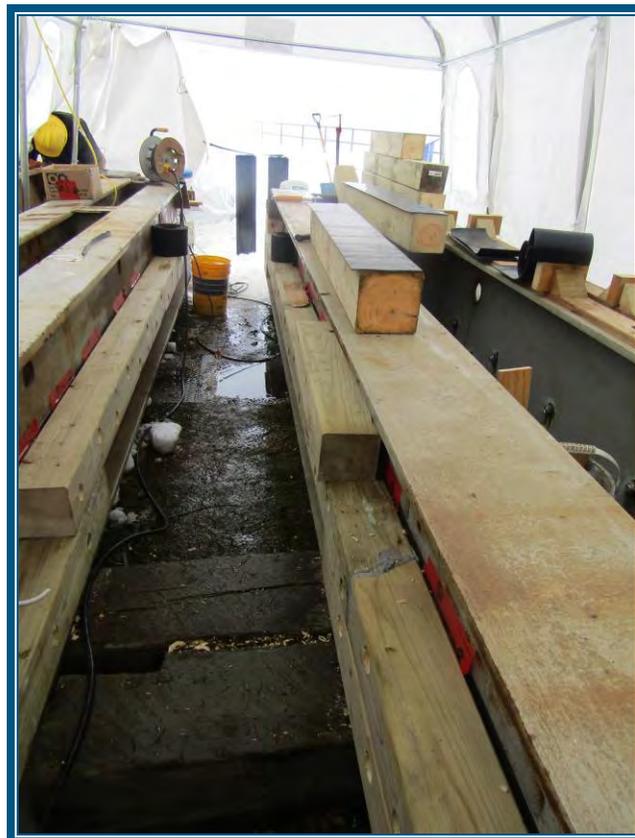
Poutrelles peintes en gris, entreposées dans des abris temporaires
